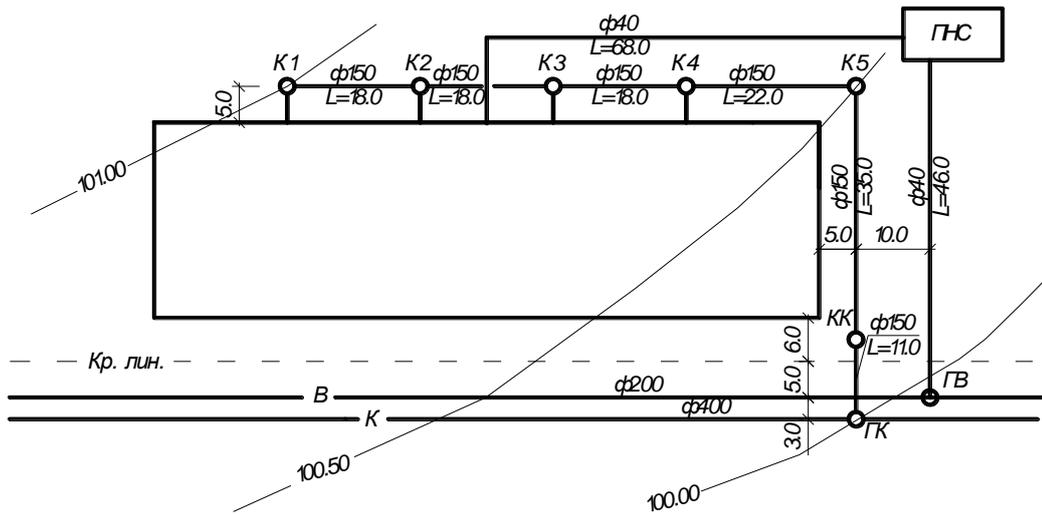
Генплан участка застройки жилого пятиэтажного дома с сетями водопровода и канализации
